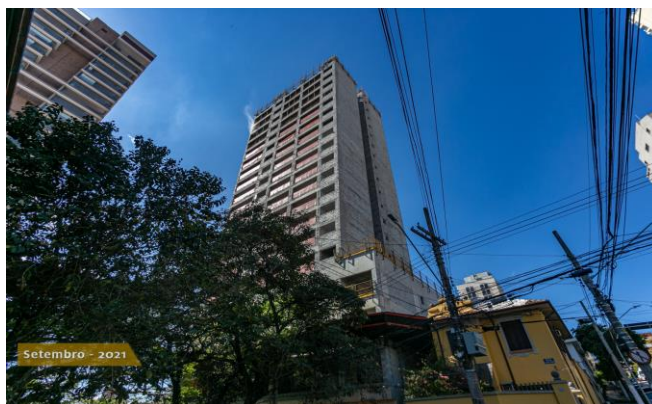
Fachada do empreendimento com 15 dos 19 pavimentos construídos.
